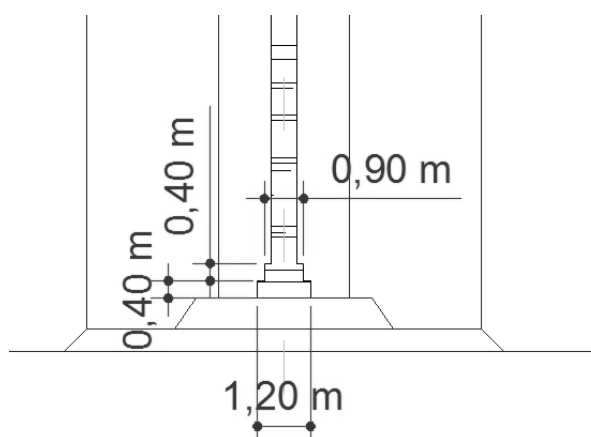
Detalhe da seção transversal da barragem Foz do Chapecó, com as dimensões do núcleo e do filtro na base (CNEC, 2006).
